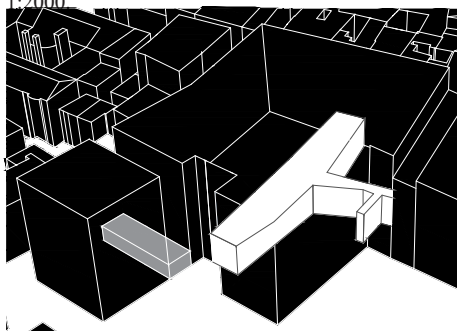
Pasáž Domu uměleckého průmyslu 1:2000.
